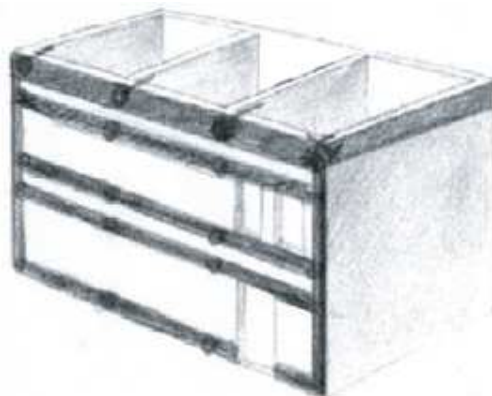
Schema di possibile soluzione di intervento per flessione orizzontale
